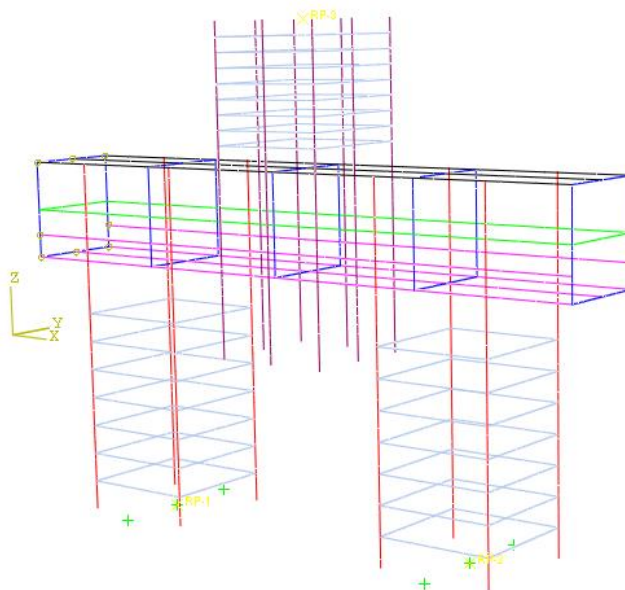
Malha de elementos finitos de barras para as armaduras do bloco B35P25E25e0
